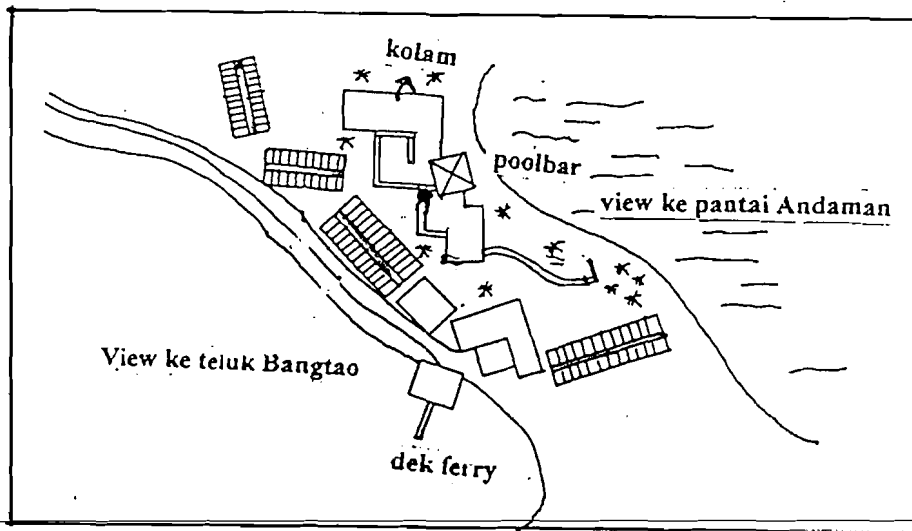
Site plan Laguna beach club, Phuket, Thailand
